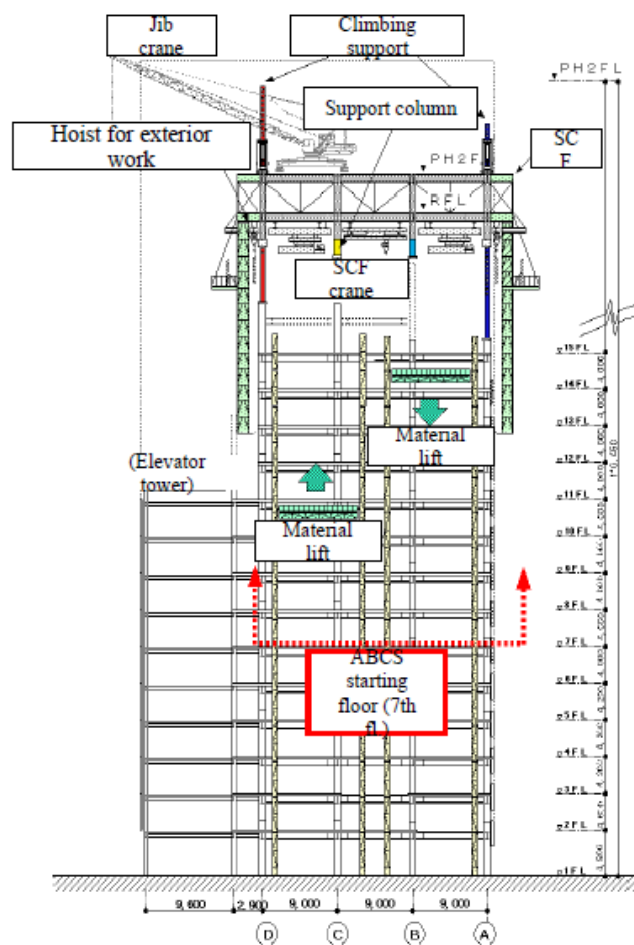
Sección del esquema de trabajo de un edificio. *Application of the automatic building construction system high-rise office building.
